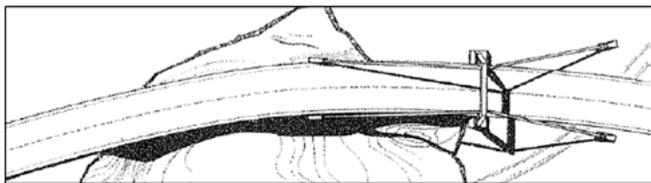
Pianta del Viadotto Ansa del Tevere.
